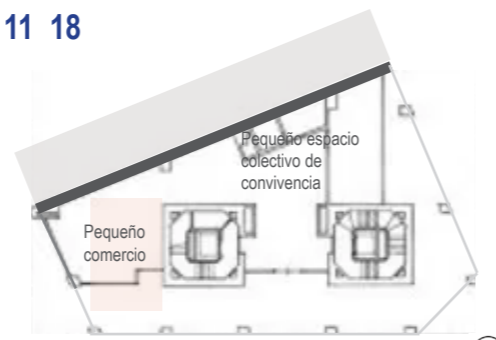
Planta acceso cota cero. Imagen con intervención propia.
